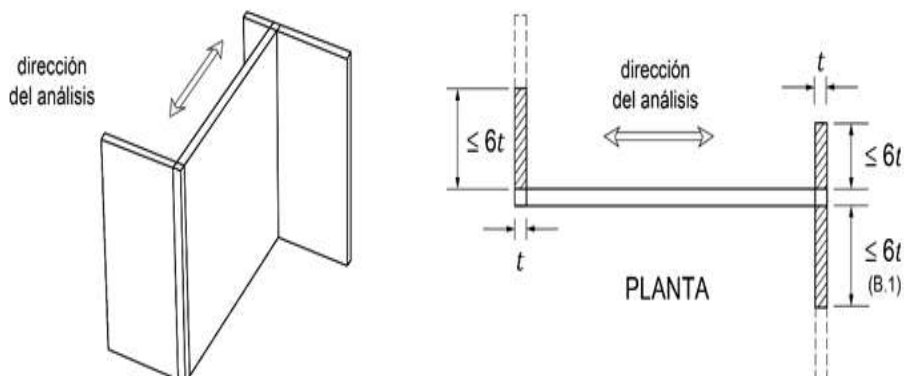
Ancho efectivo del patín a compresión en muros para análisis a base de marcos planos
